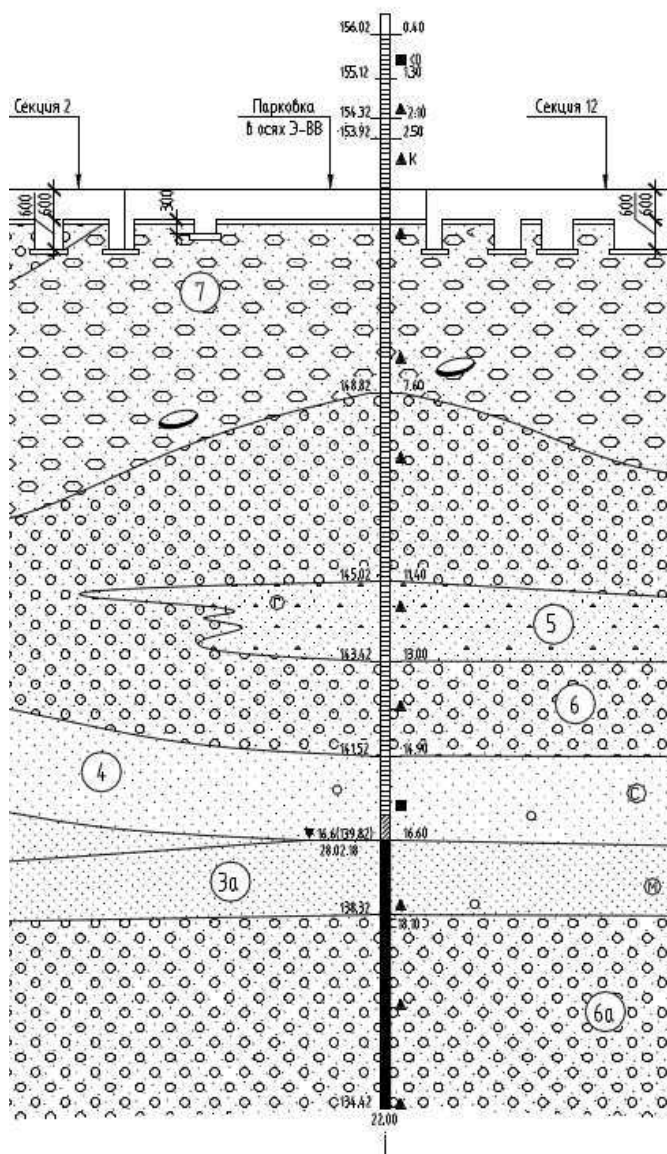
Схема расположения фундаментной плиты в грунте
